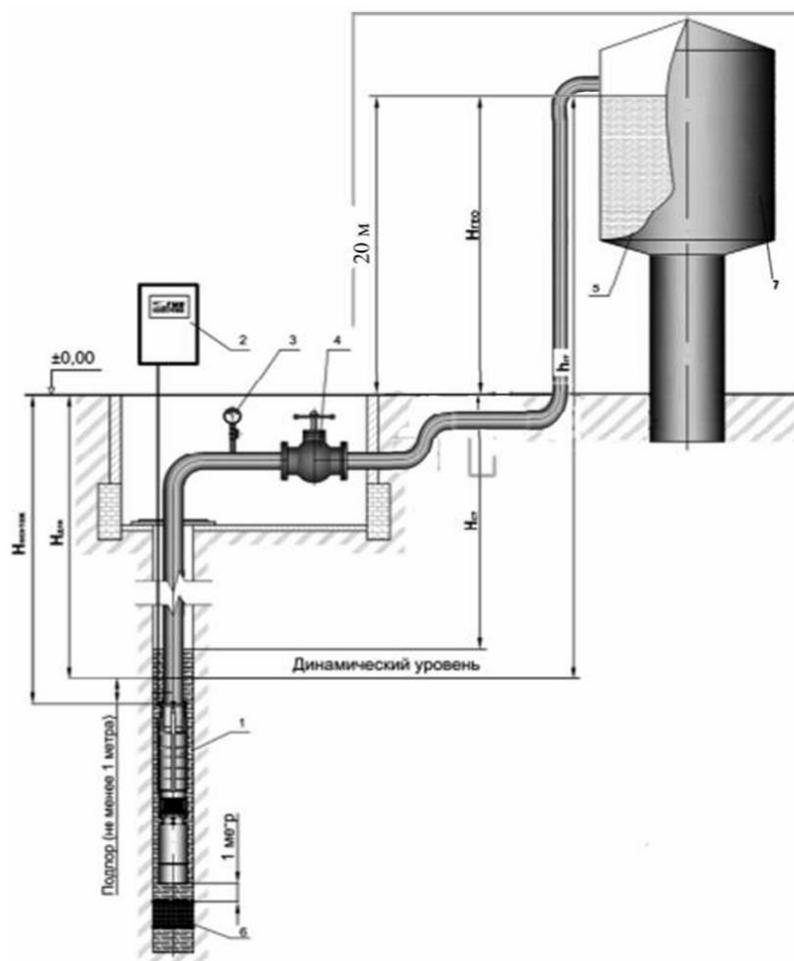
Схема скважины с трубопроводом и водоприемной башней:
